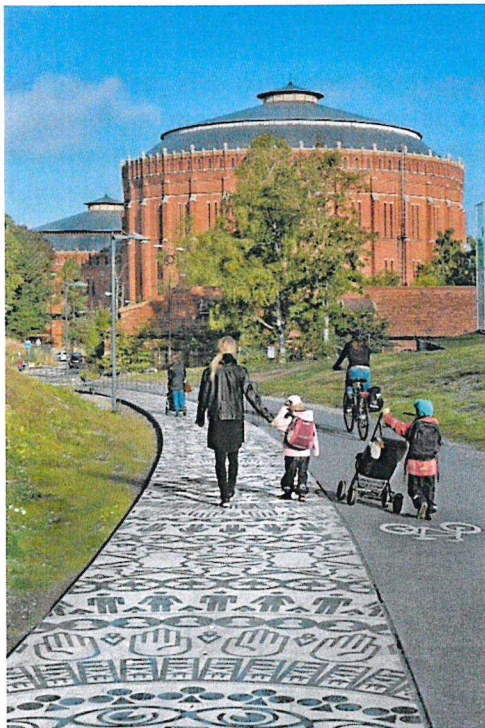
Konstnärspaltor med GK 2 i bakgrunden.
